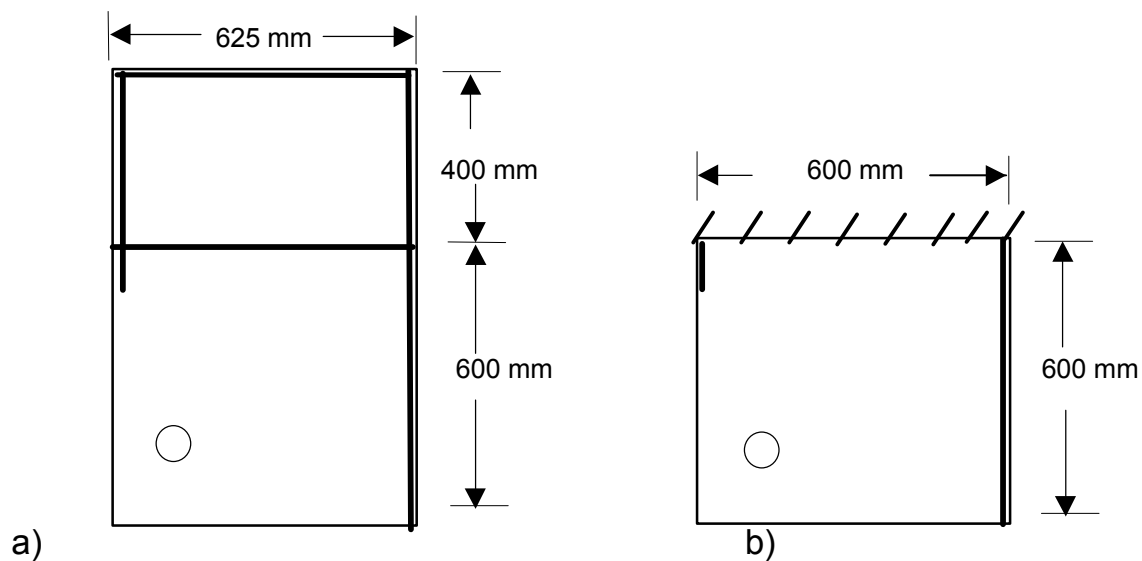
Versuchskörpergrundriss mit Randbedingungen
